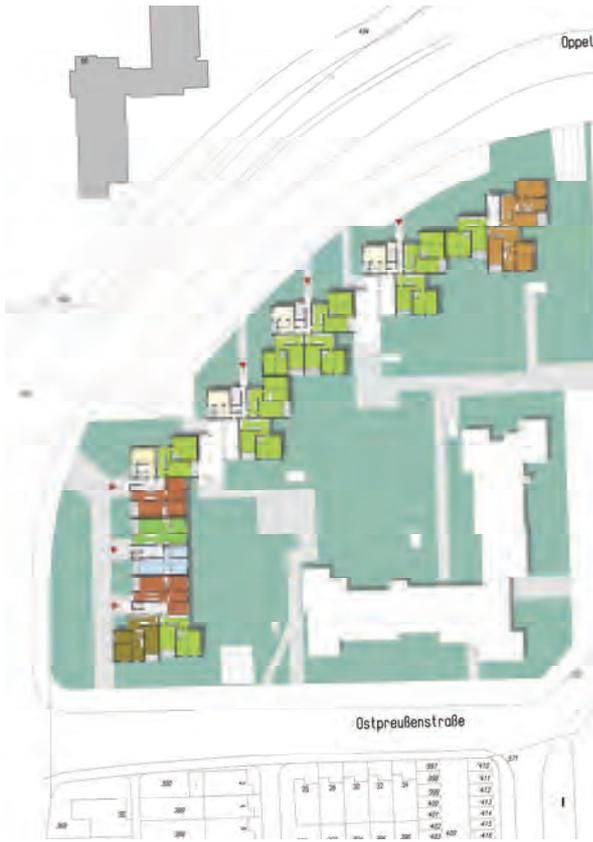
Grundriss Erdgeschoss West Bestand
